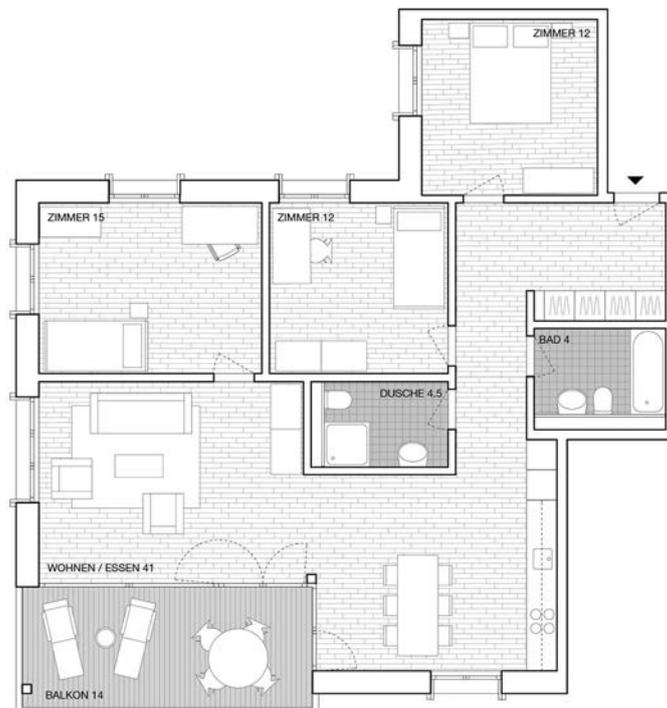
Wohnungsgrundriss 4.5 Zimmer - Whg.
